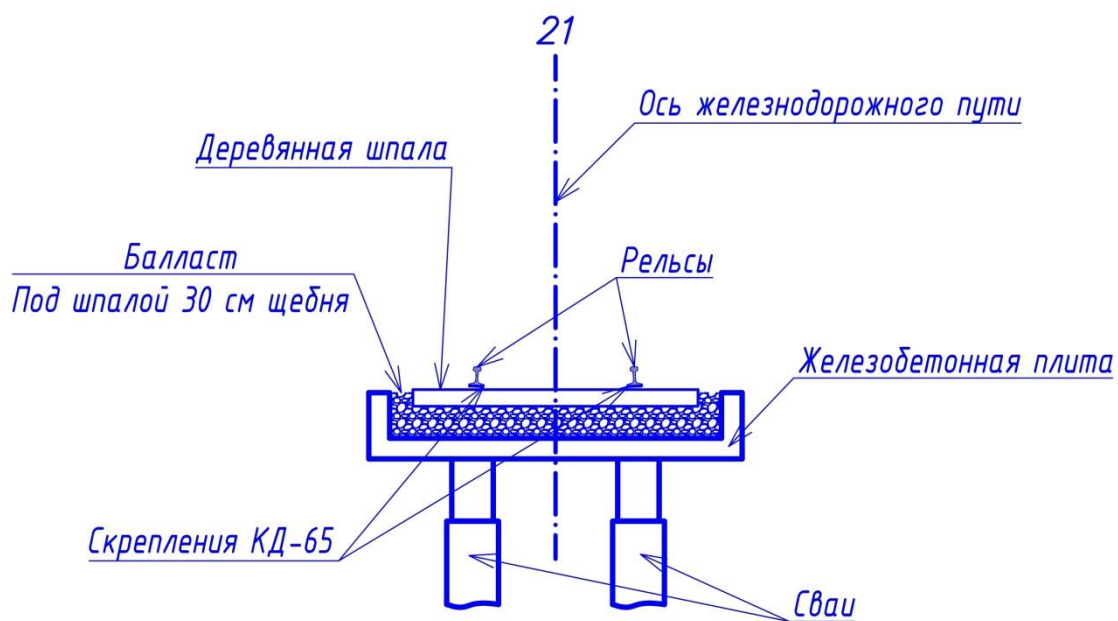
Конструкция верхнего строения пути на железобетонной плите
